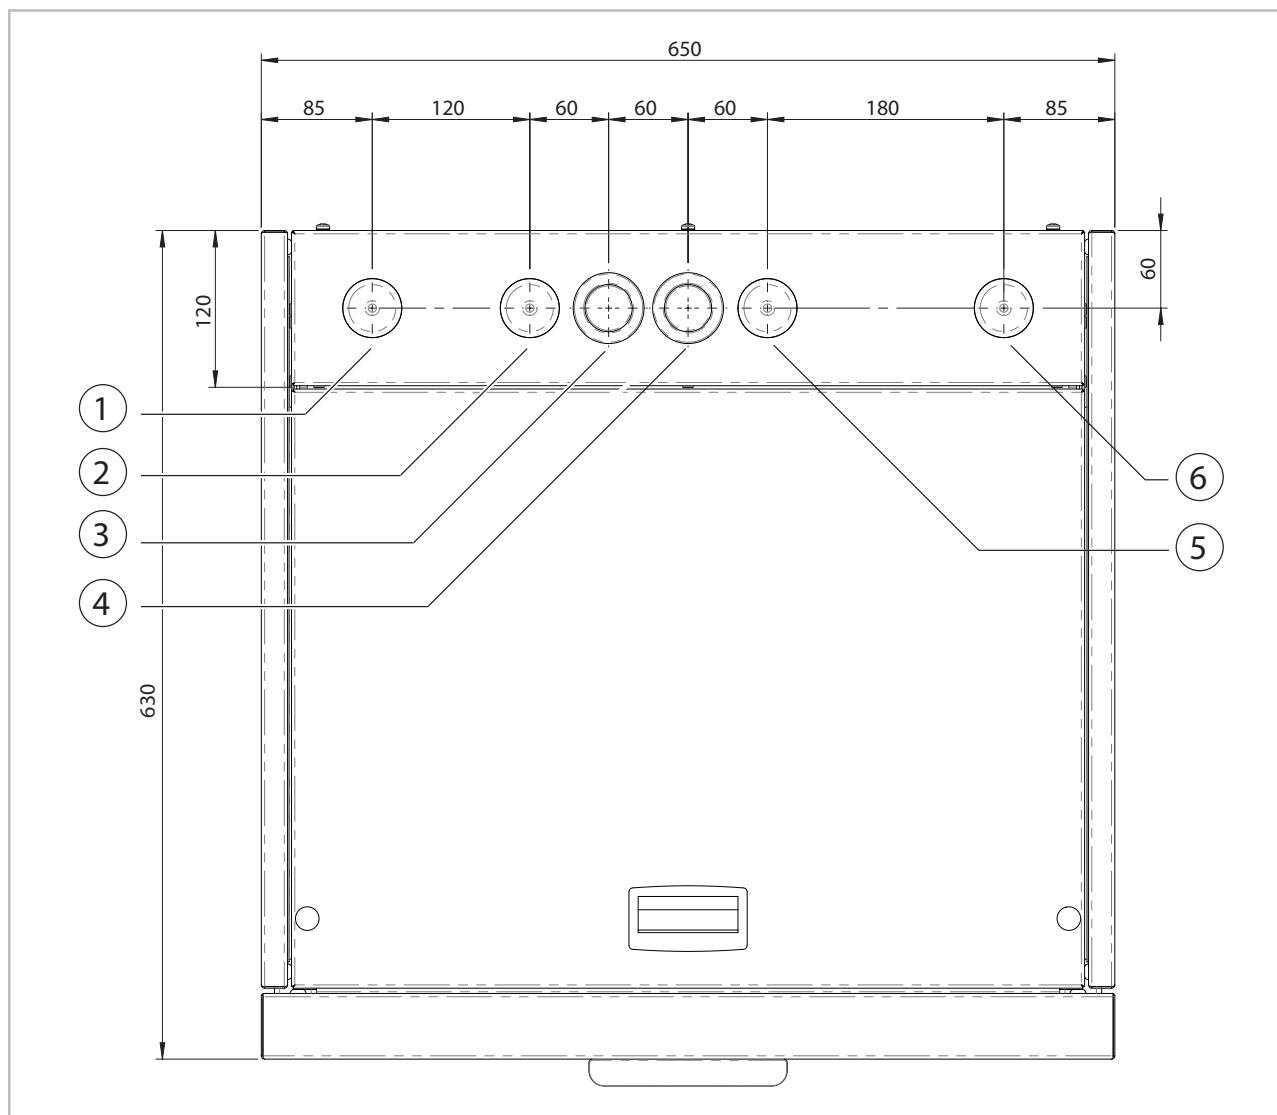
Bezeichnungen der Rohranschlüsse, Draufsicht
